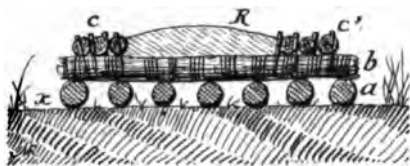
Coupe en travers d'une chaussée en terrain marécageux.
